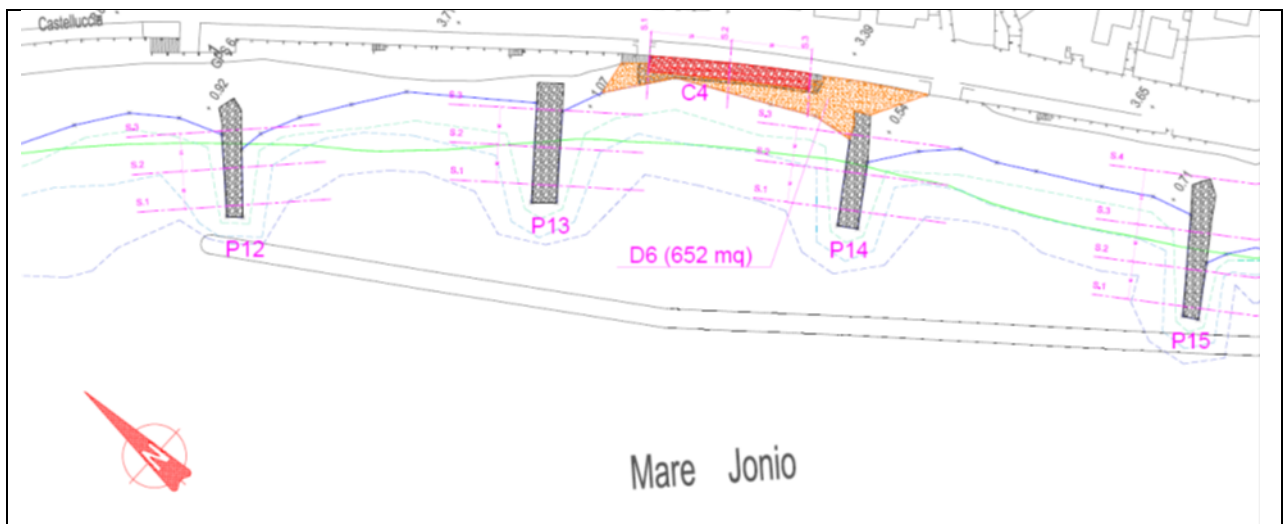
Schema planimetrico intervento Lazzaro area A lungomare Cicerone tratto Gardena
